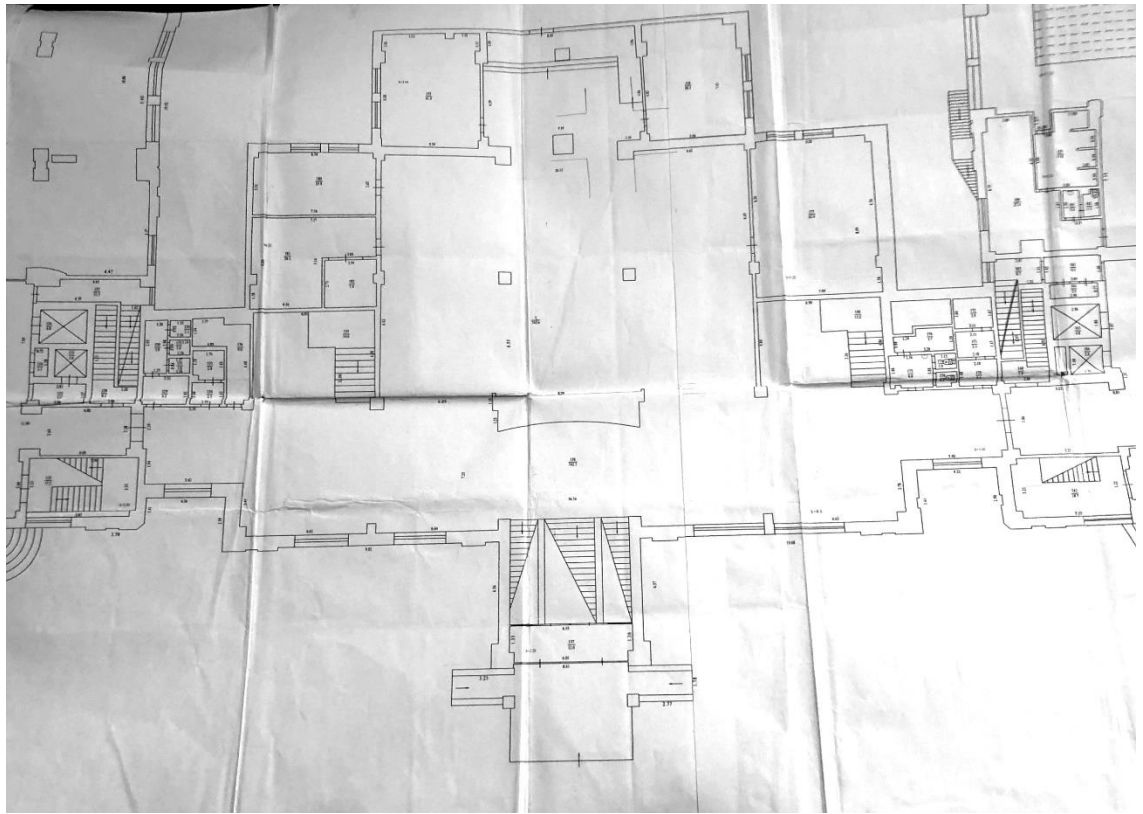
Фрагмент плану 1-го поверху будівлі учбового корпусу літ. «А-2-6-8».
